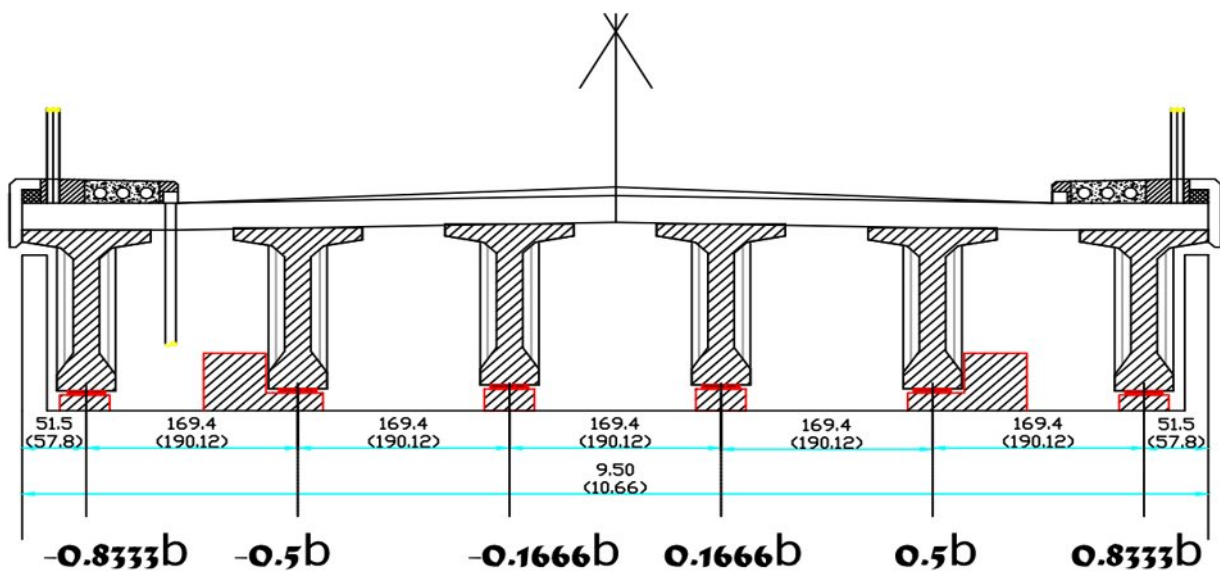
REPARTITION TRANSVERSAL DES POUTRES
